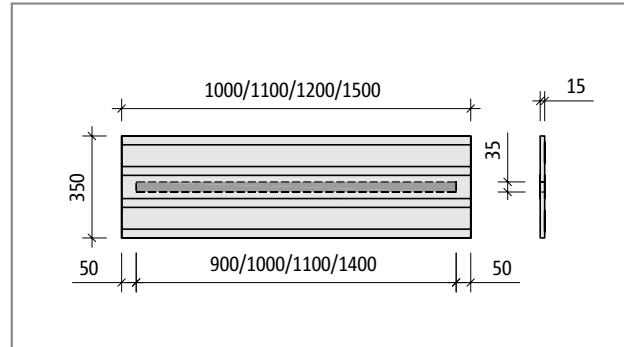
Schöck Tronsole® Typ B-V2-L...-B350: Produktgrundriss
